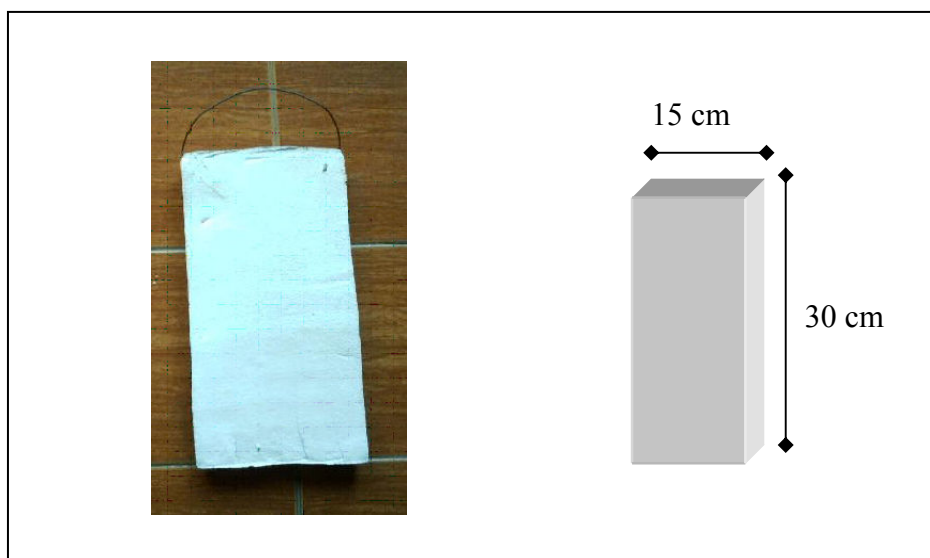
Painel de cimento e argamassa. (Foto: Flayane Höehr Silva)
